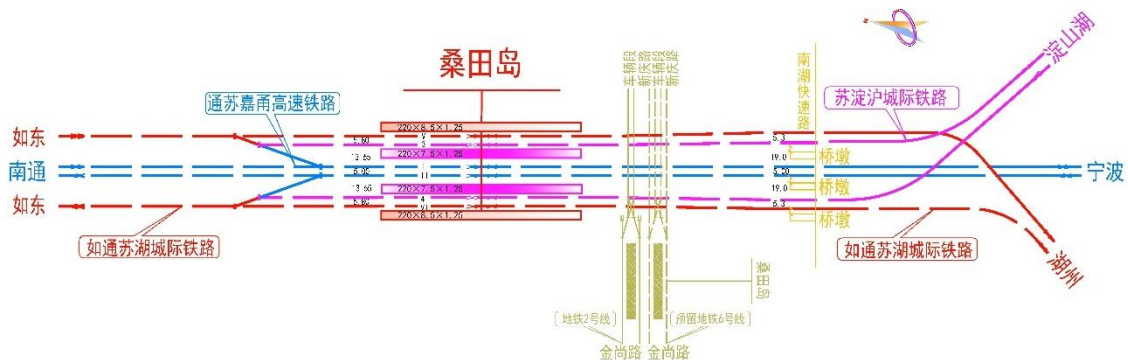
桑田岛站 4 侧 6 线方案平面布置示意图
